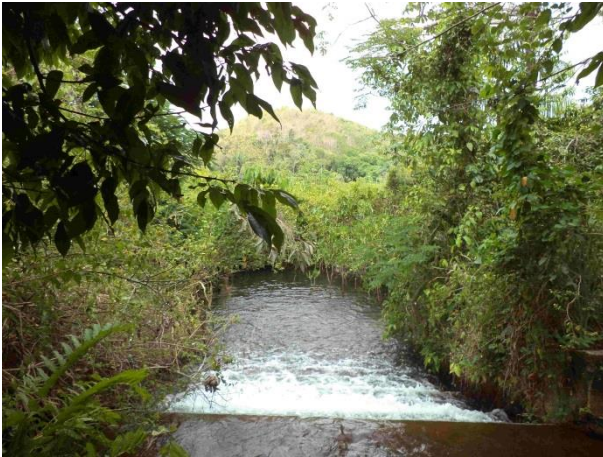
Montante da travessia 166, em outubro de 2013. Foto: Amplo
